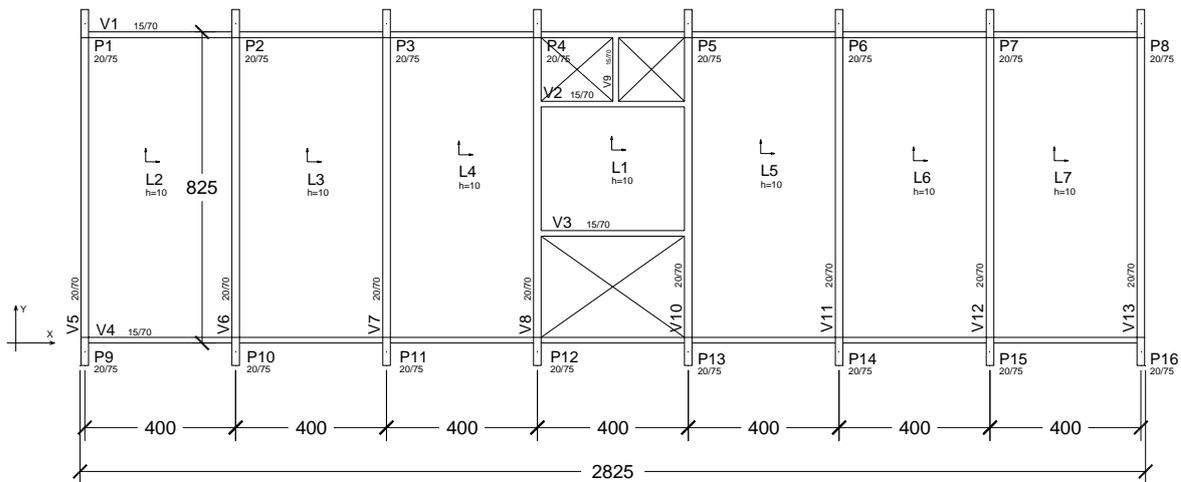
Planta baixa do pavimento tipo do Edifício 01 (FRANÇA, 1985)
